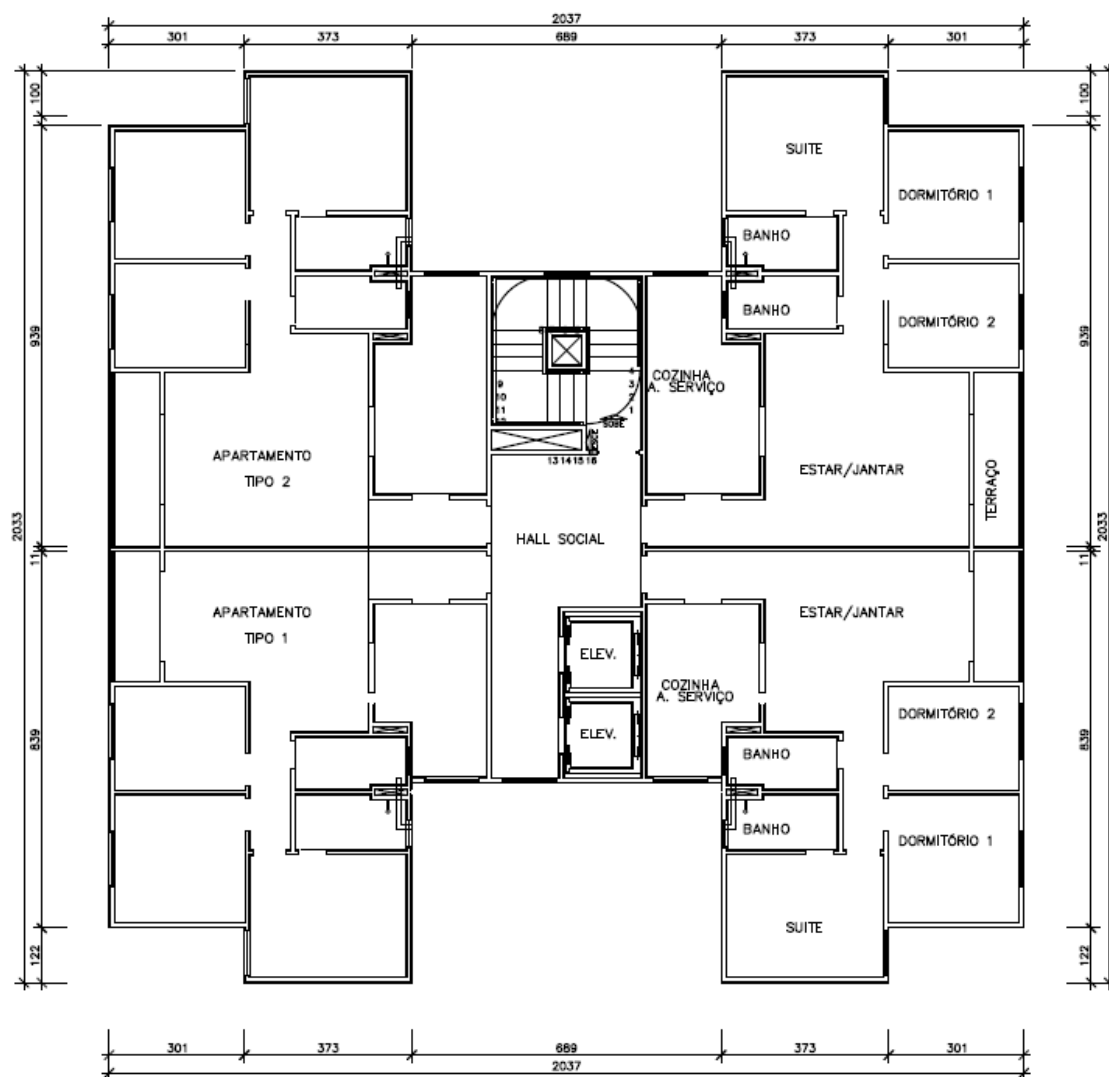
ARQUITETÔNICO – PAVIMENTO TIPO
